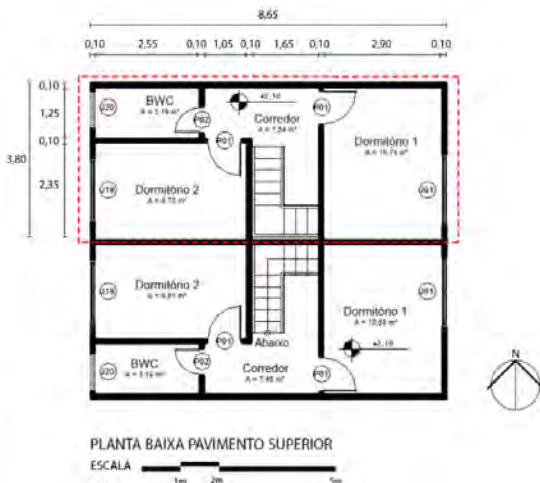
Planta baixa do pavimento superior da edificação de referência.
